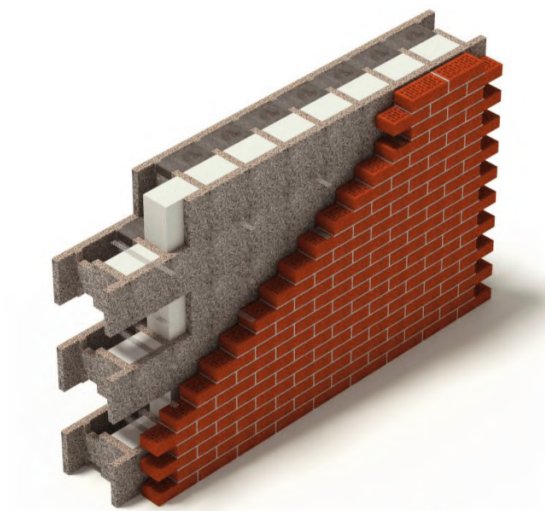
Варианты отделки фасада наружной стены из блоков
